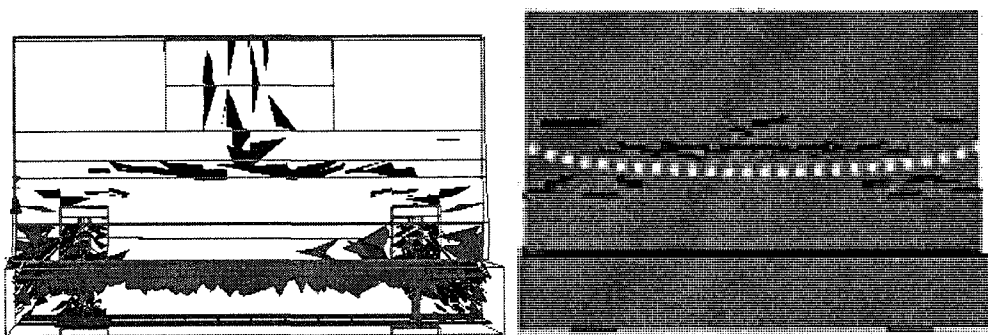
27: Fissuration du parapet en BRF 120MPa-4%
